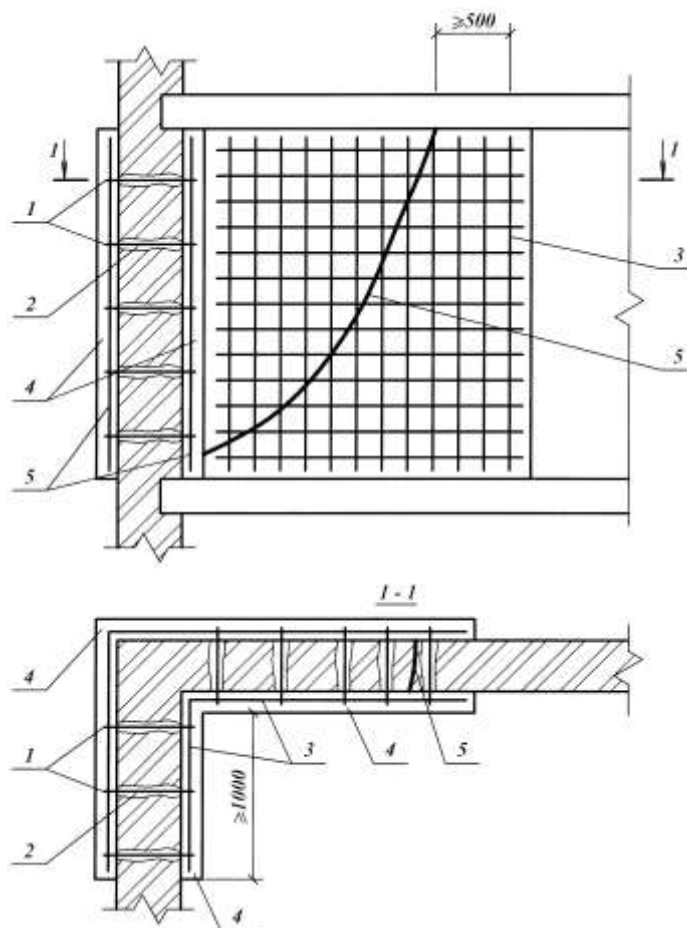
Усиление стены с трещиной арматурными сетками в слое торкретбетона (торкретштукатурки):
